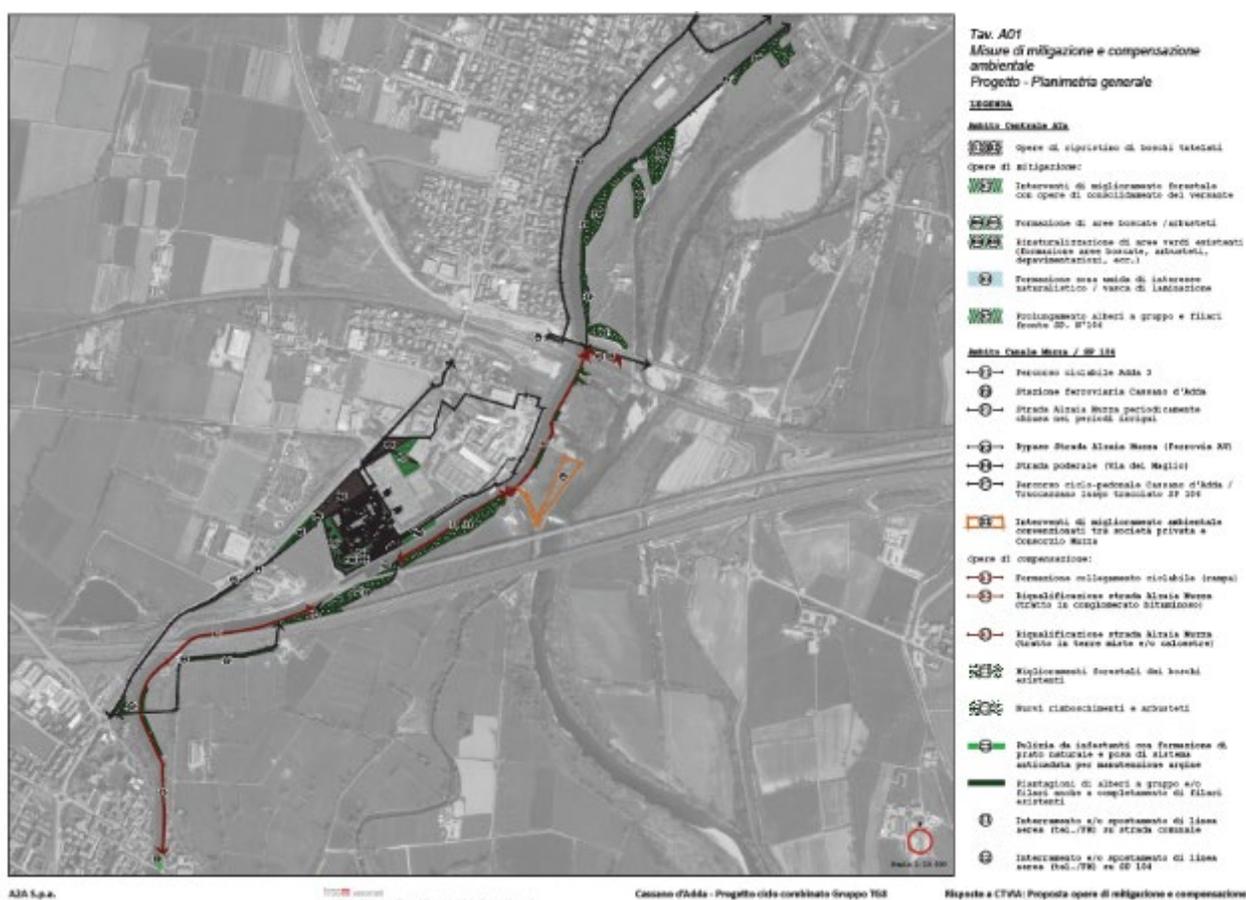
Misure di mitigazione e compensazione ambientale – planimetria generale
